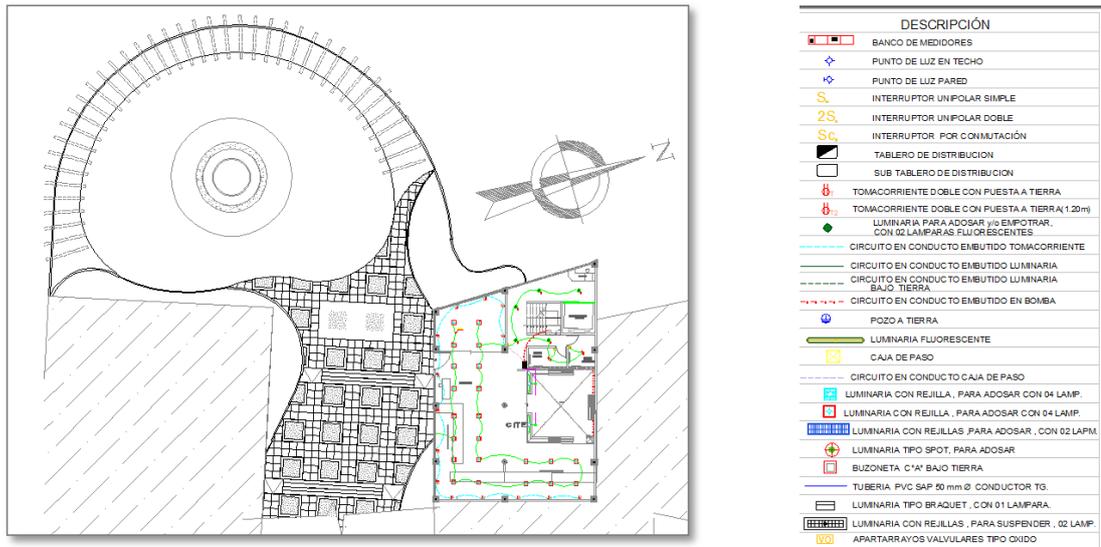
Instalaciones Eléctricas Primer Nivel del Proyecto
